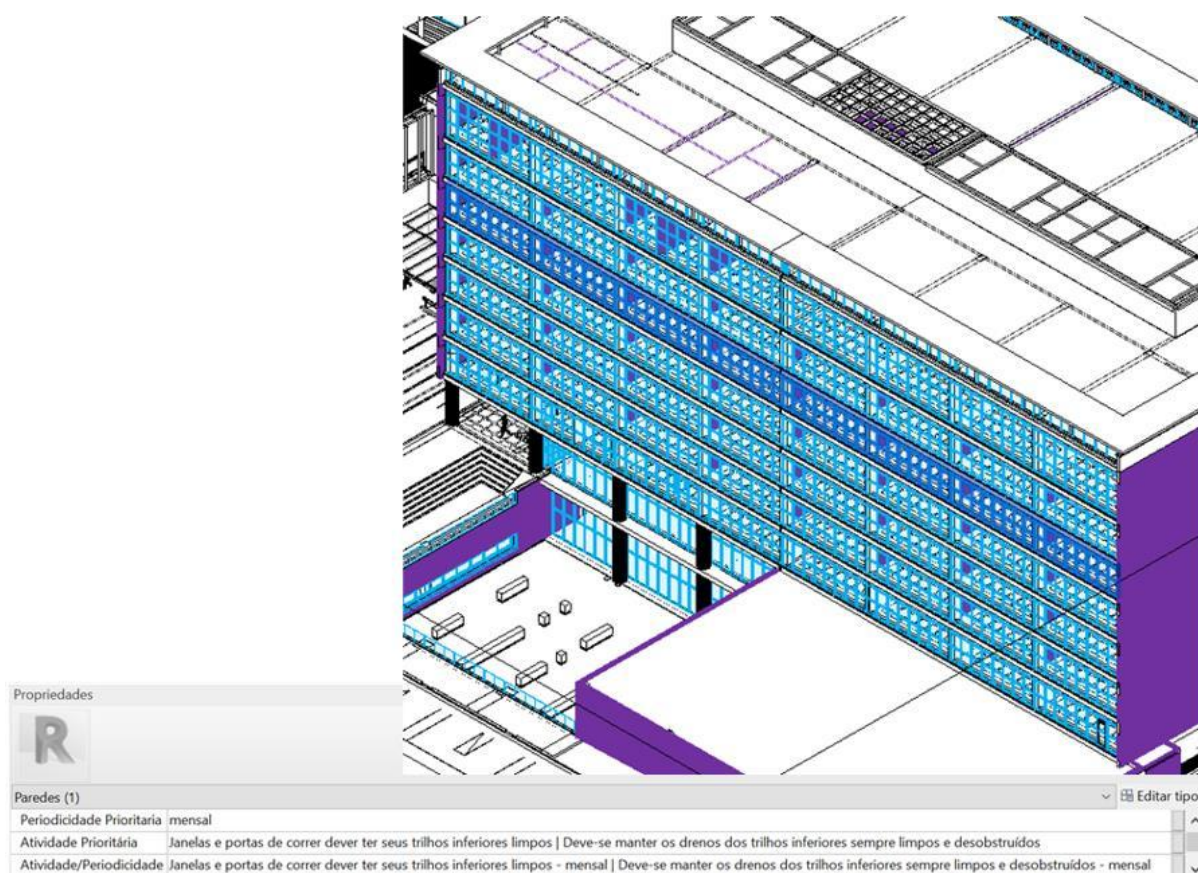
Parâmetros no projeto para manutenção constante dos elementos do sistema de estruturas e paredes
